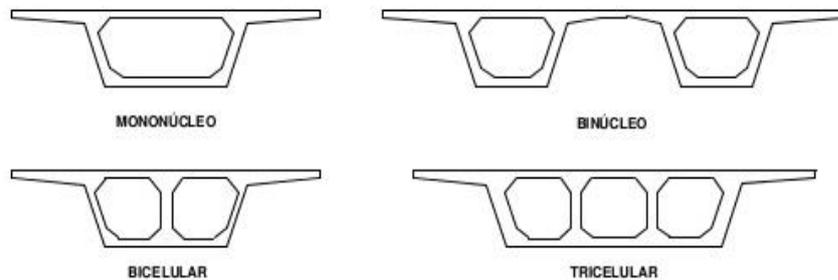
Secciones tipo viga cajón. Fuente: (Structuralia, 2016).
